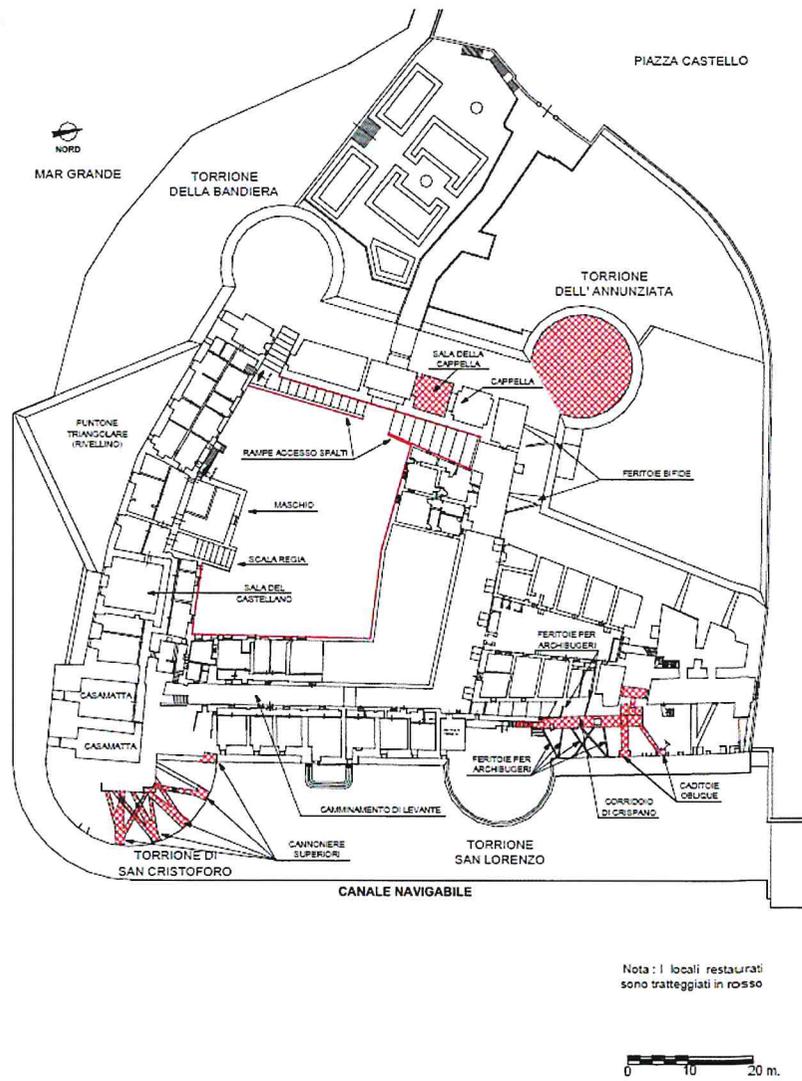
Planimetria attuale del piano degli alloggi del Castello.
